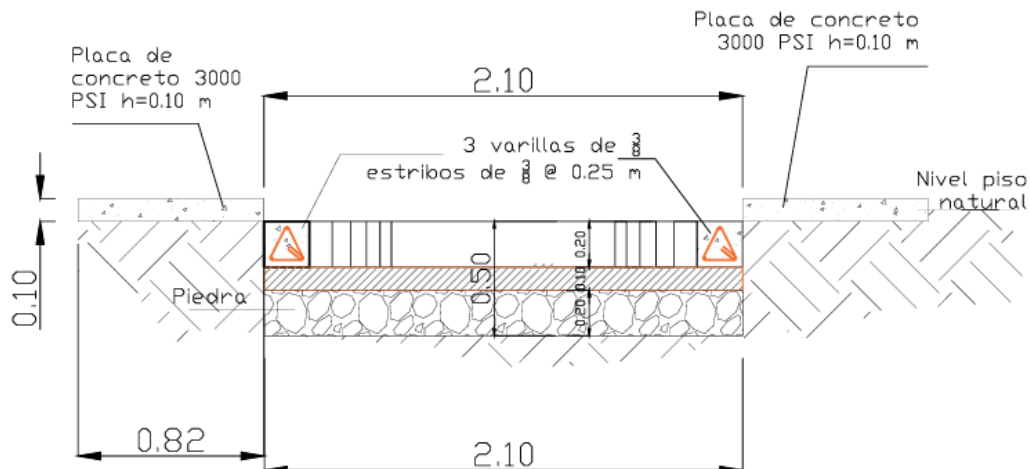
Construcción estructura de cimentación SICAL - Plástico
